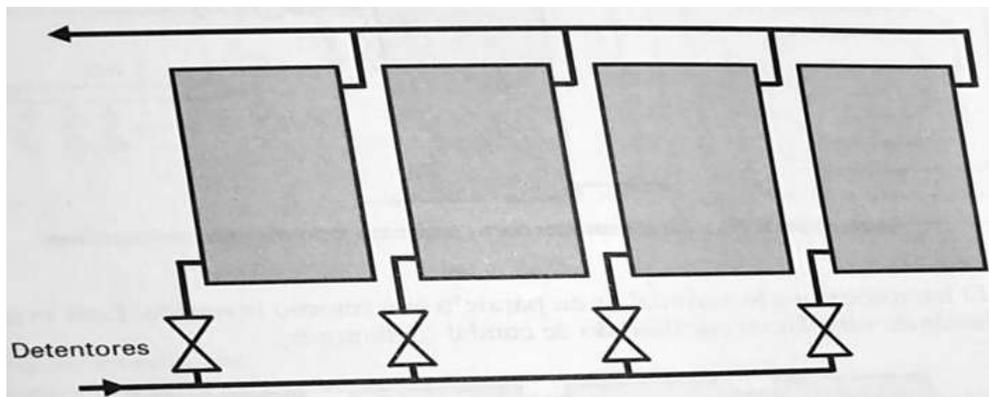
Interconexionado en paralelo con tubería exterior y válvulas
